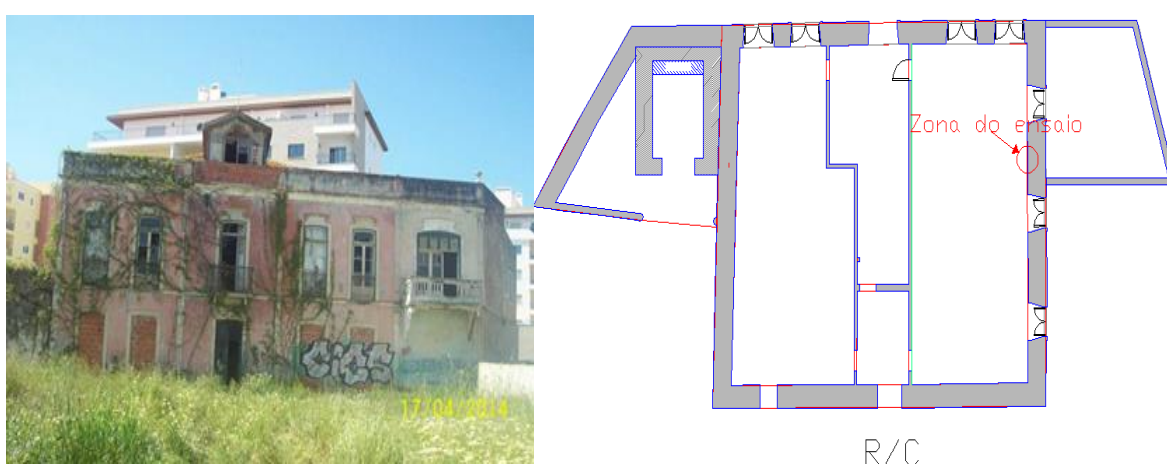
Alçado principal da casa das palmeiras (Lagos), e localização do ensaio na planta do r/c.
